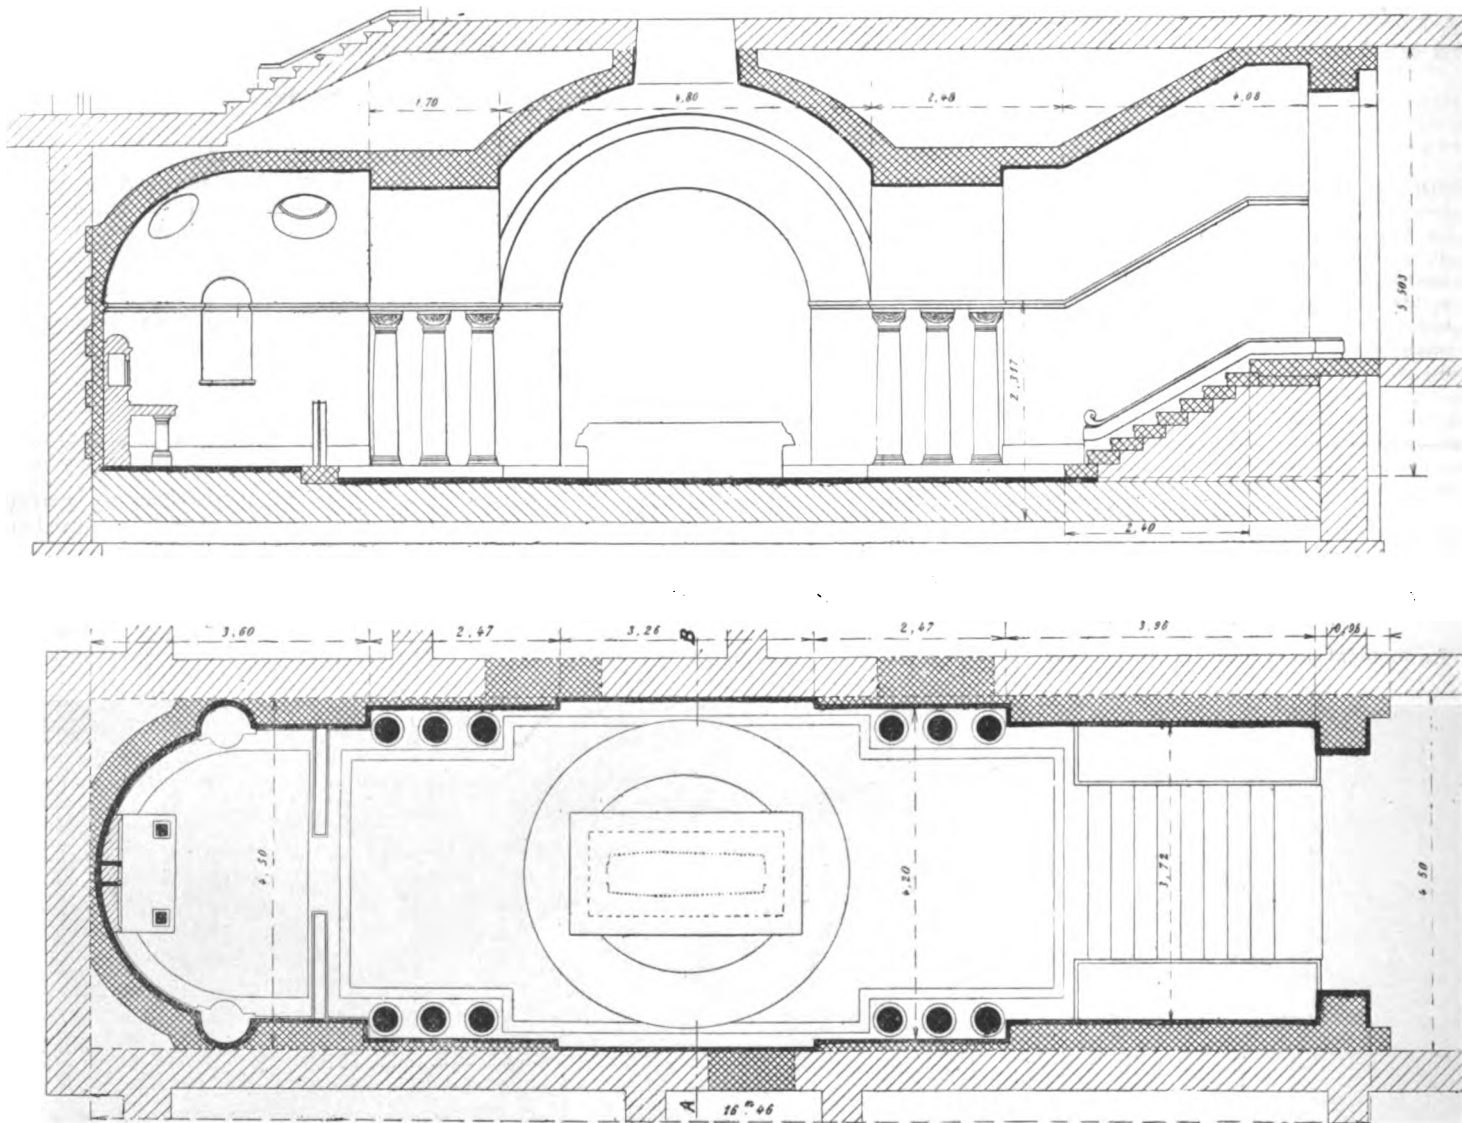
et 3. — LA CRYPTÉ DE L'INSTITUT PASTEUR : Coupe longitudinale et plan.
